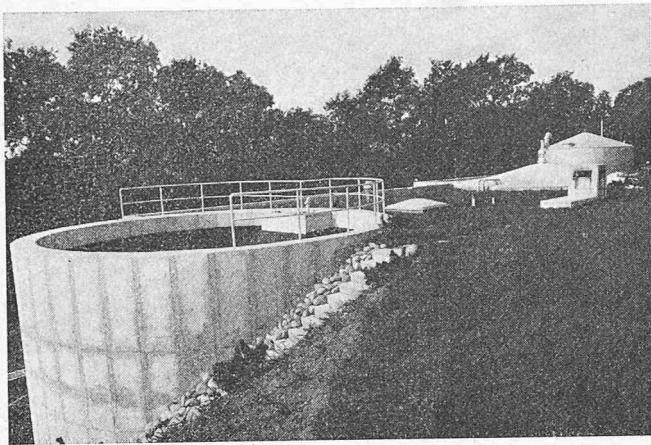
Betriebsgebäude und Faulanlage sind in den natürlichen Hang hineingebaut. Im Vordergrund der offene Nachfaulraum, dahinter der Kamin, die Betondecke des Vorfaulraums und die Gasometerglocke
